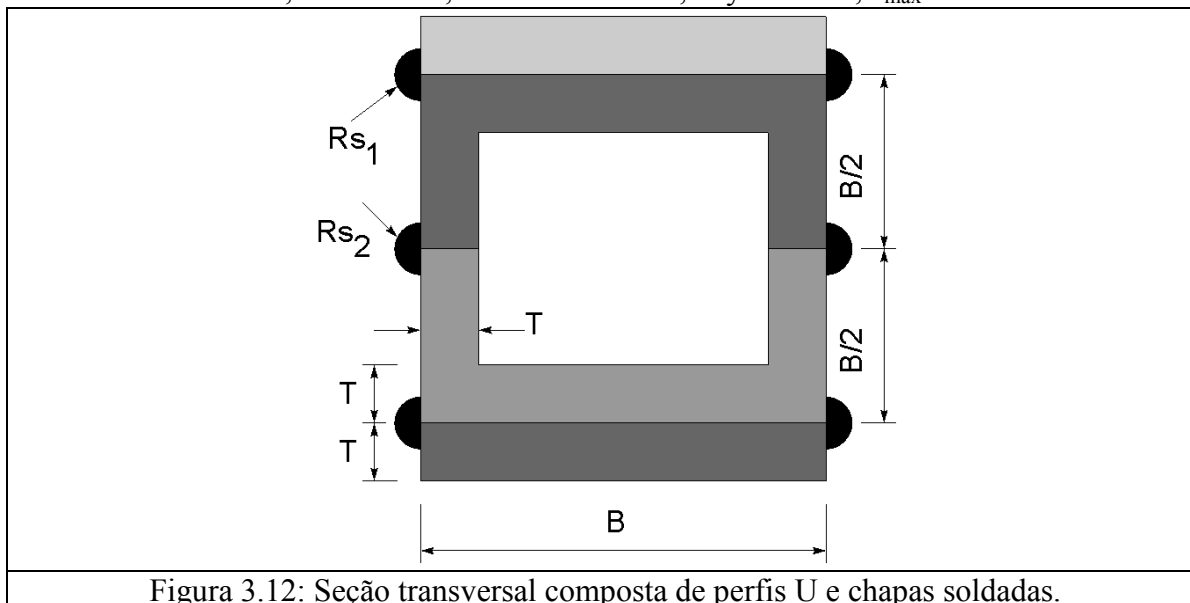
Seção transversal composta de perfis U e chapas soldadas.
